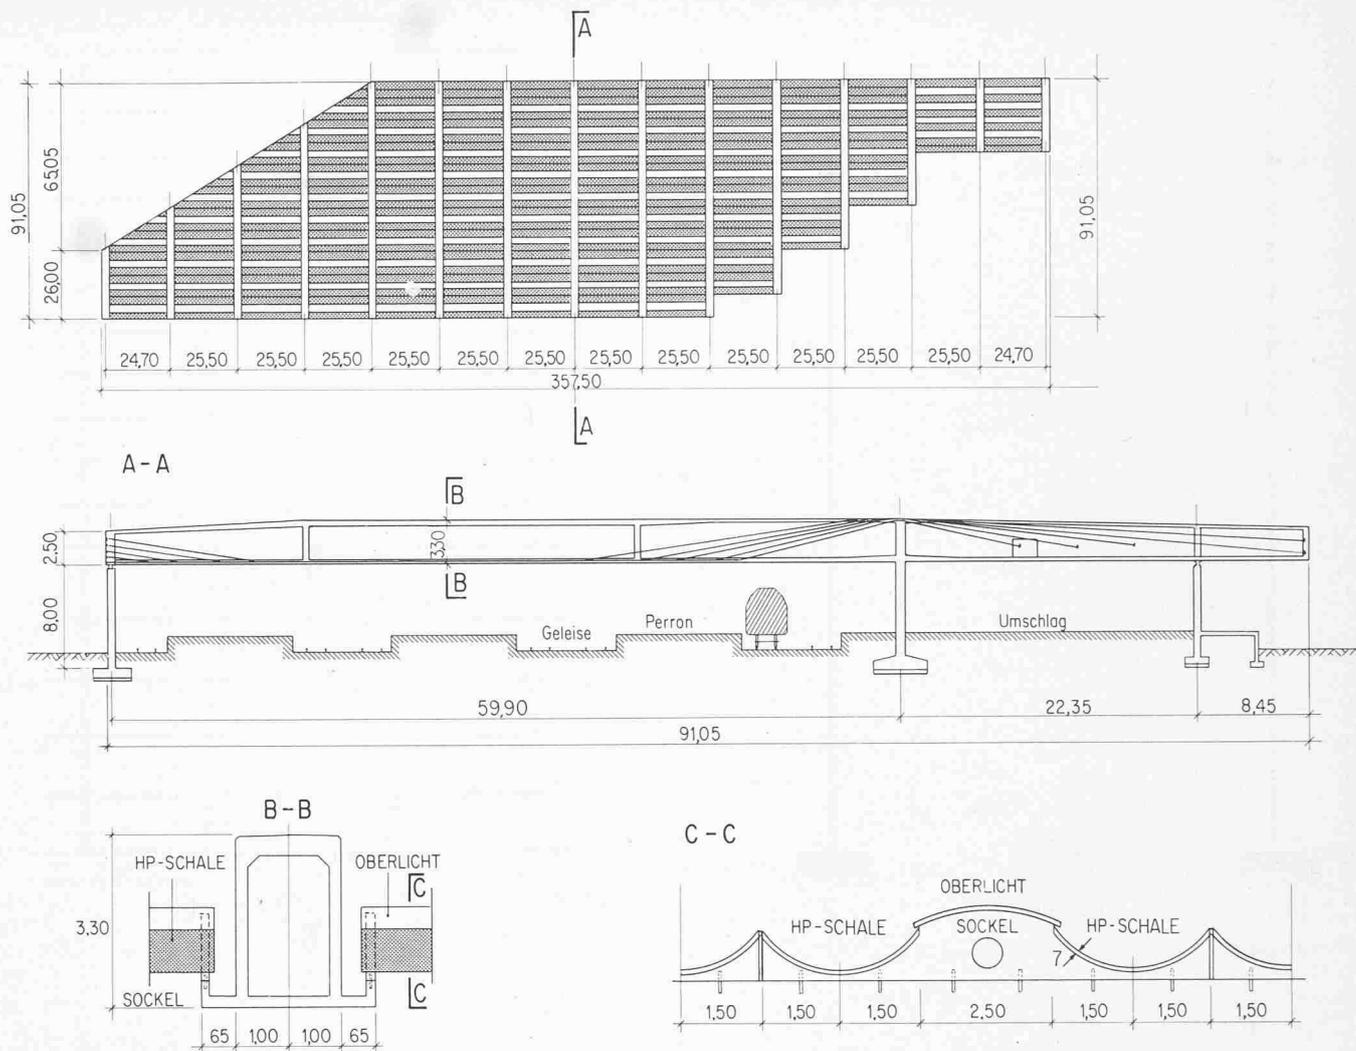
Schnellgut-Halle der Schweizerischen Bundesbahnen in Zürich-Altstetten (Grundriss Schnitte und Kabelplan)
